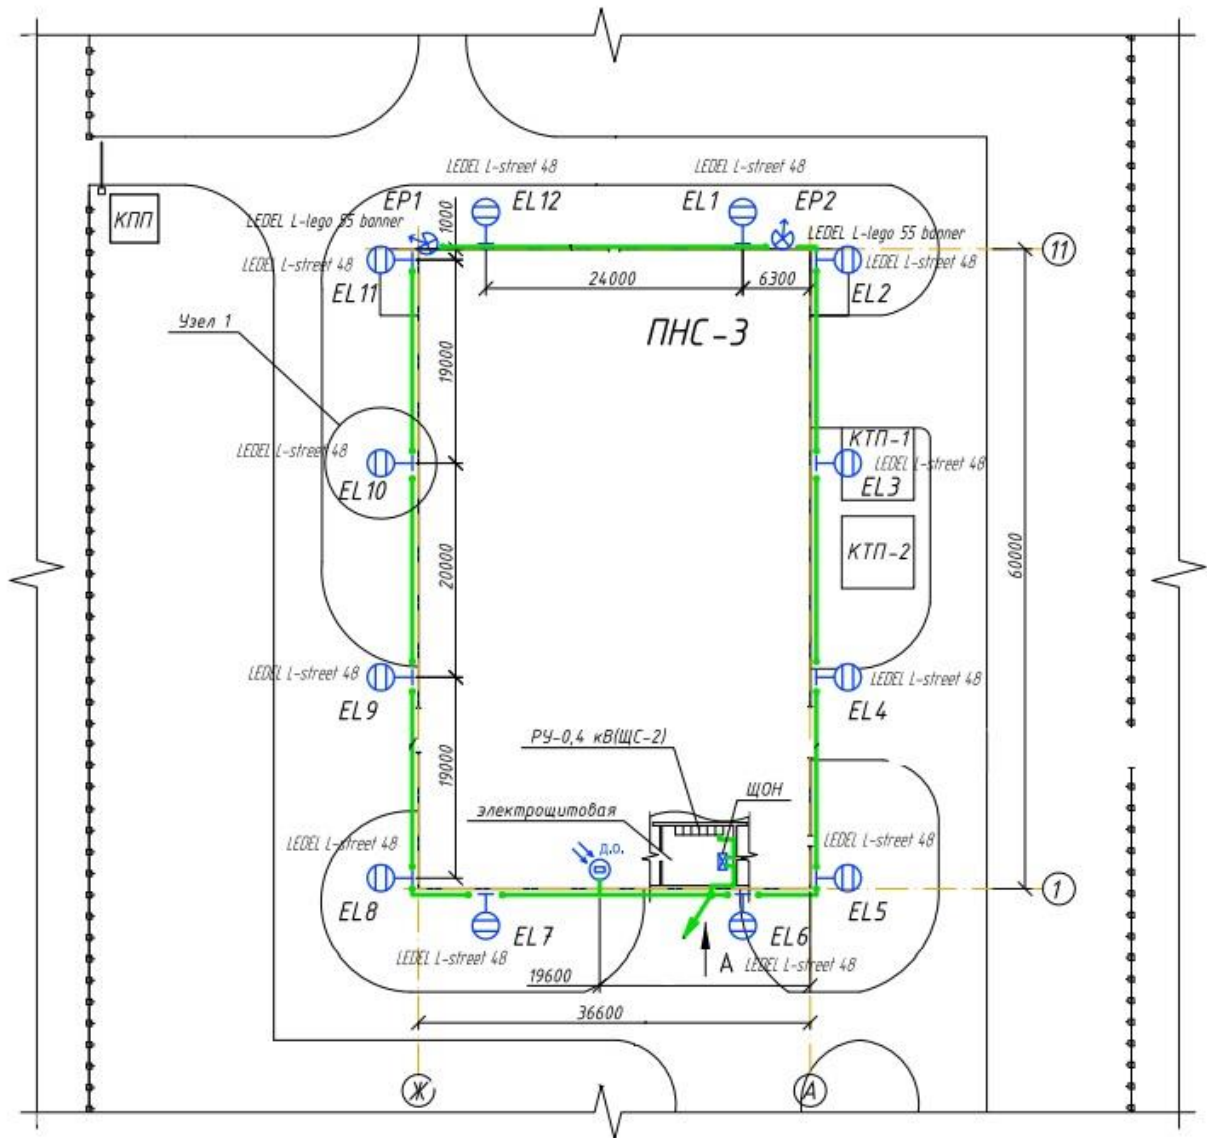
План наружного освещения насосной станции с установленными светодиодными светильниками
